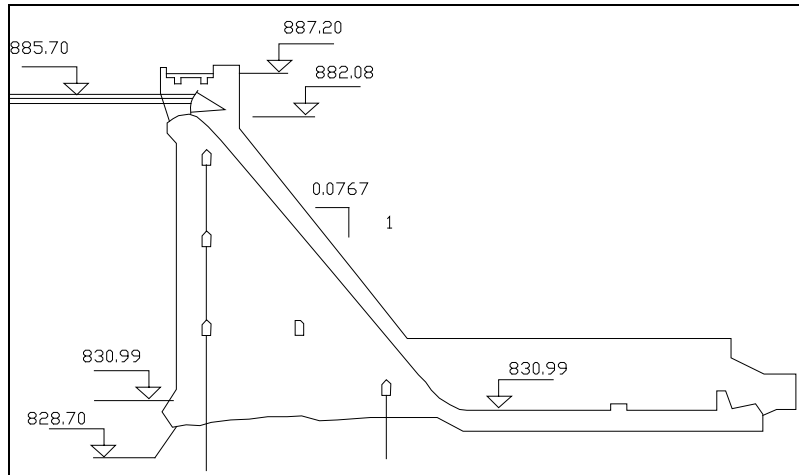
Sección transversal de la estructura de la presa Santa Teresa. Escala 1:1350.
